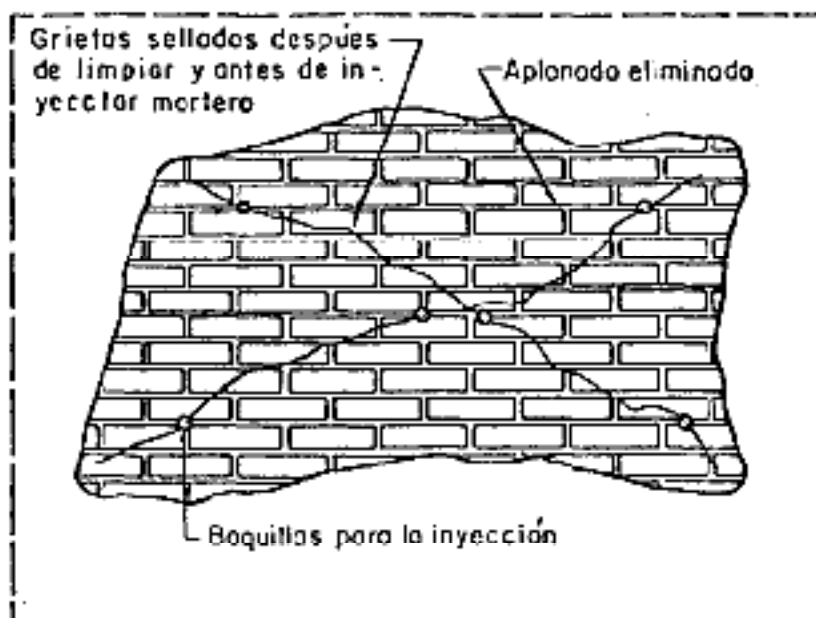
Inyección de grietas en muros de mampostería (ref. 9)
